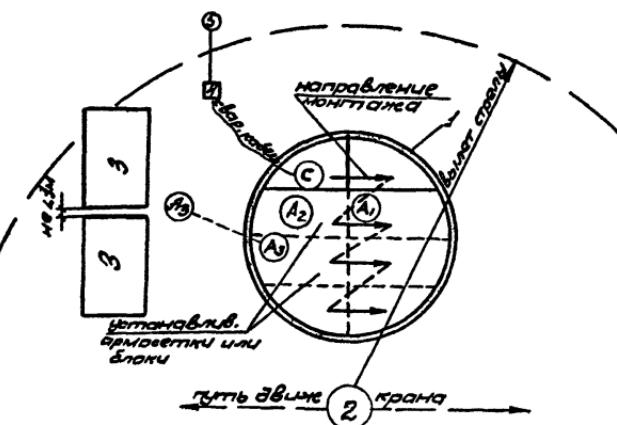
Схема организации рабочего места при укладке армосеток или армоблоков
